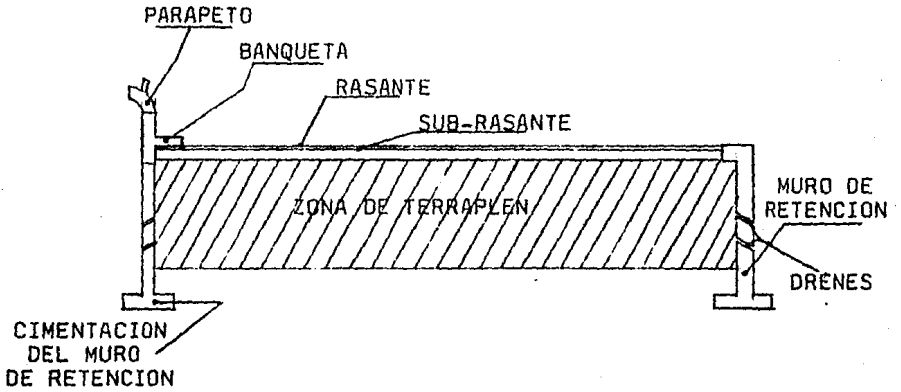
TERRAPLEN DE ACCESO Y ESTRIBO
